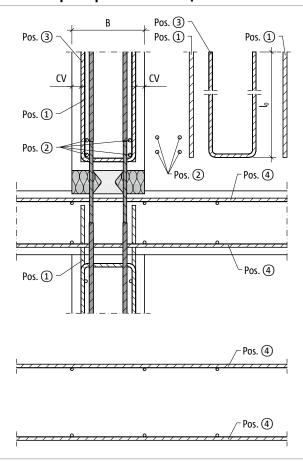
Schöck Sconnex® type W-VH-L : renforcement sur site dans le cas d'un ancrage de l'effort de traction
